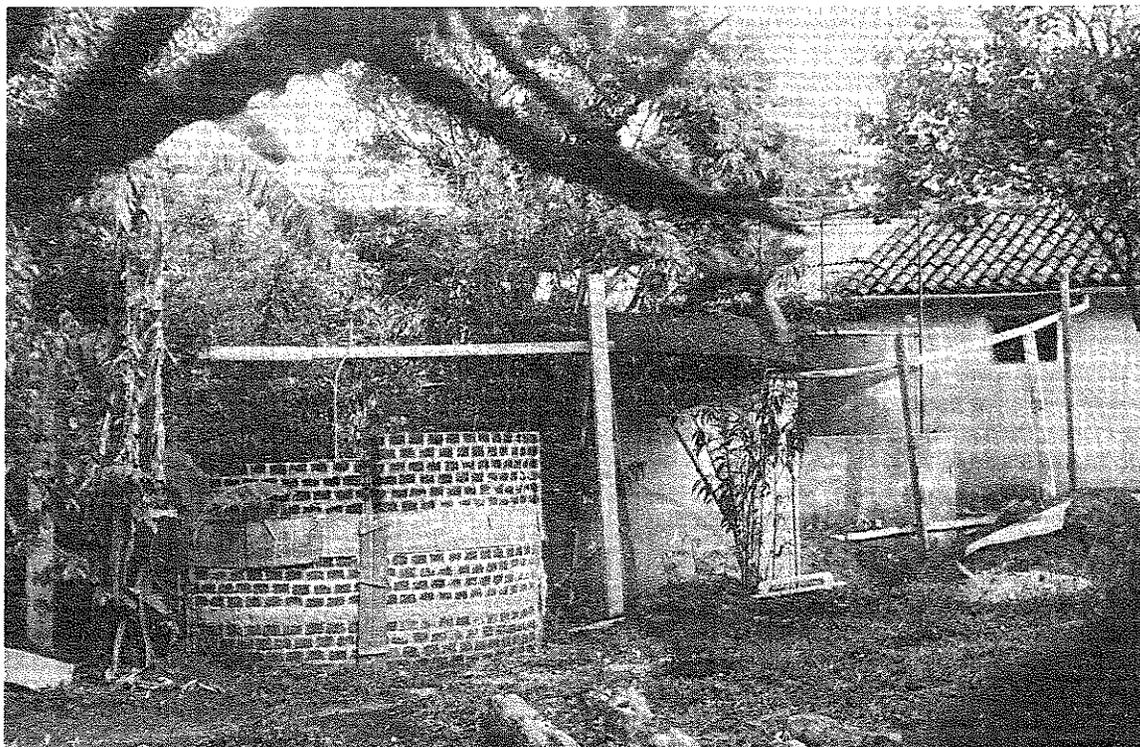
Primera Planta Piloto de Biogas, construída en la ciudad de Guatemala, 1953.
